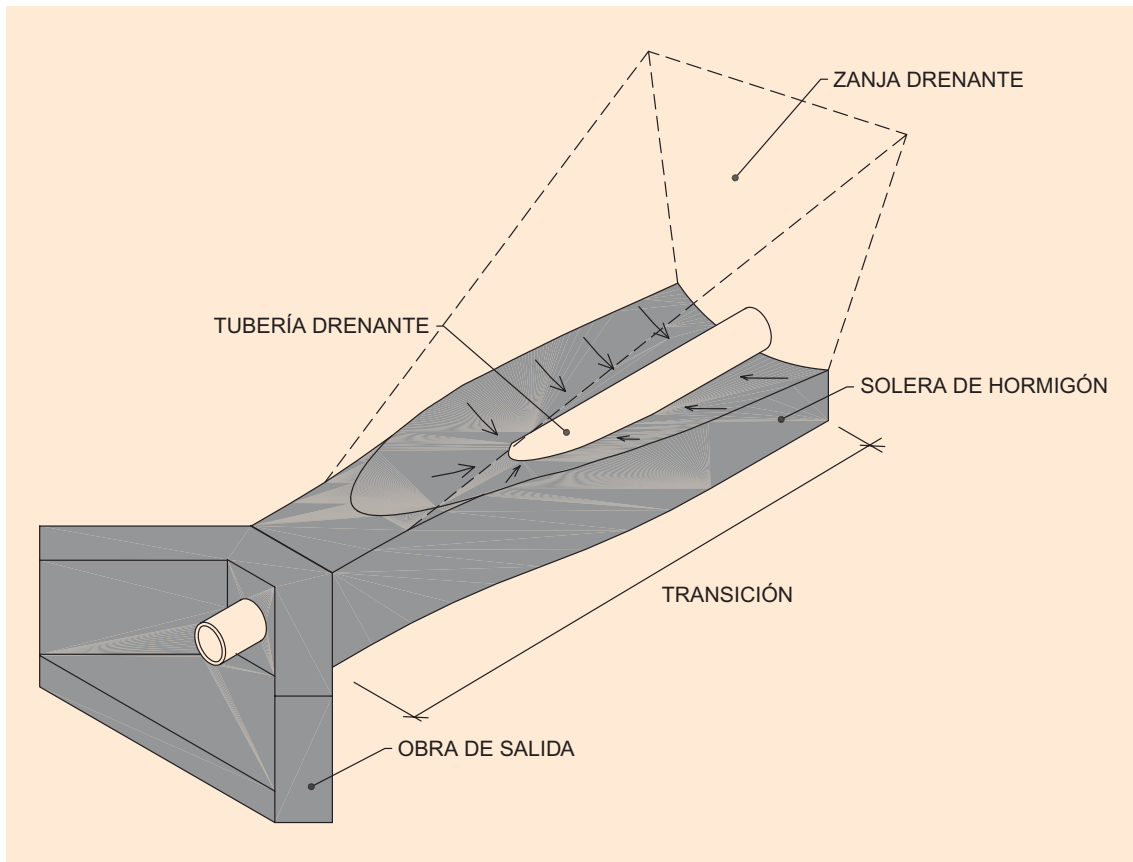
DESAGÜE DIRECTO DE UNA ZANJA DRENANTE
